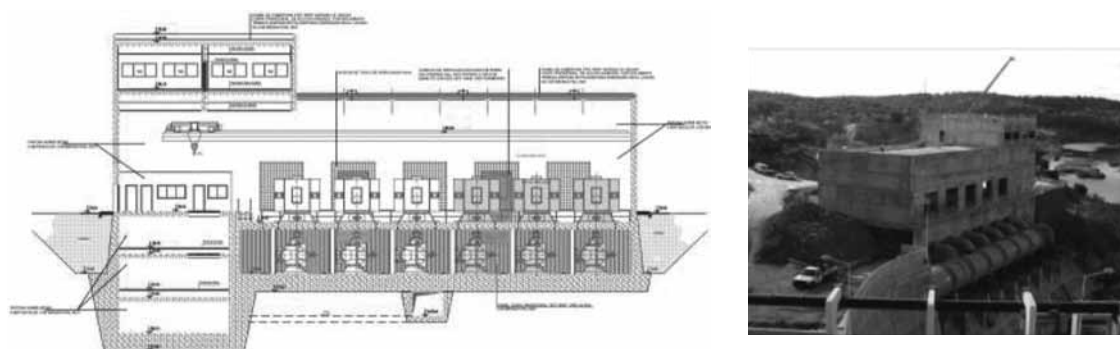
Estação Elevatória de Pedrógão. Corte Longitudinal e Vista da Obra.
